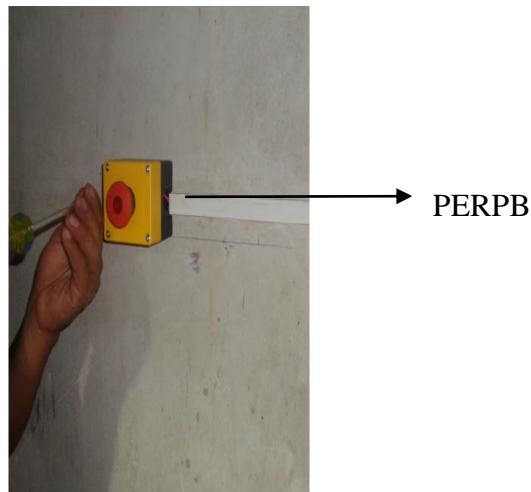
Pulsador de paro de emergencia instalado en el recinto planta baja
